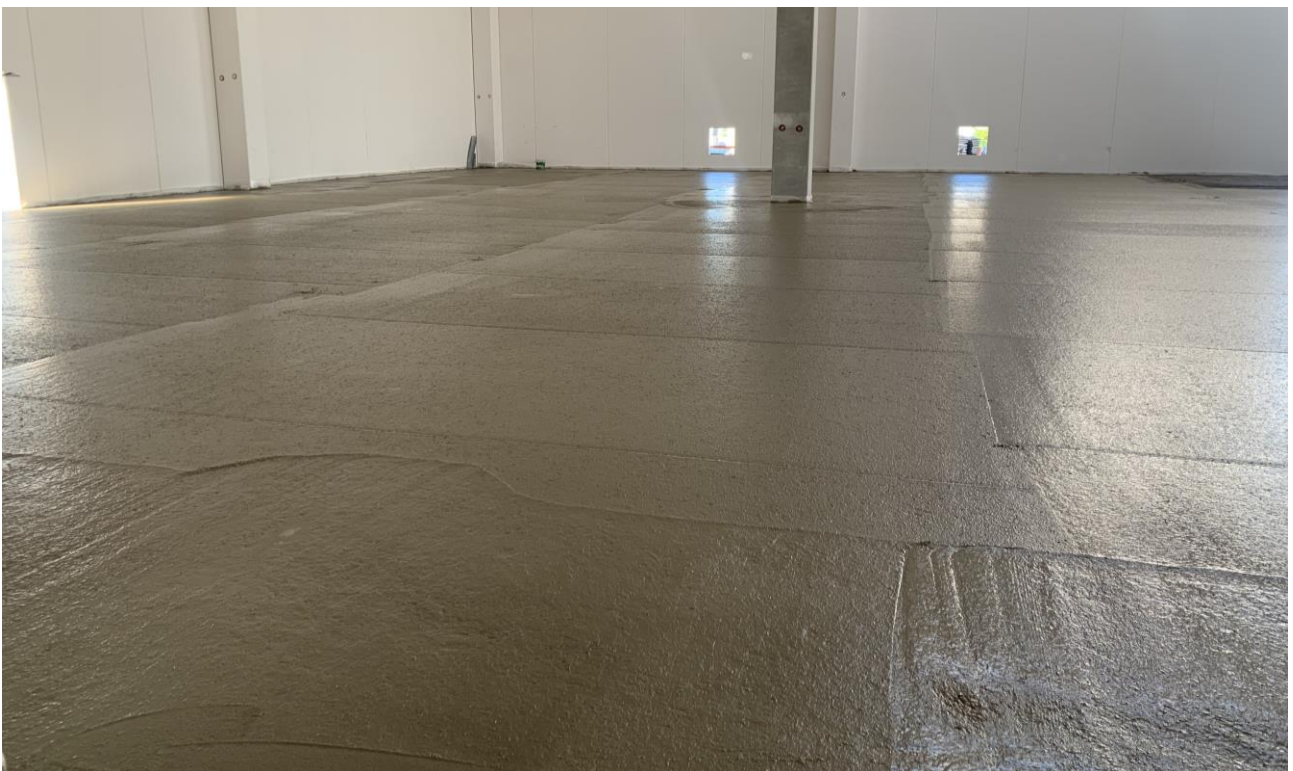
Fasi di getto della pavimentazione fibrinforzata con FIBRAG® POLY: PSF 55-TP
